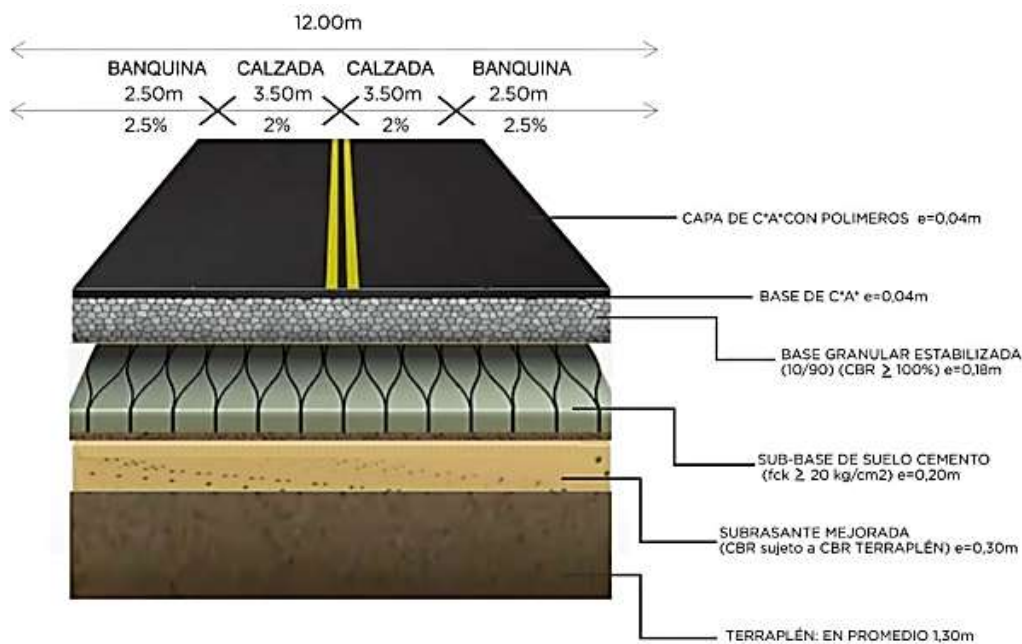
Paquete estructural de un pavimento flexible con materiales mejorados
